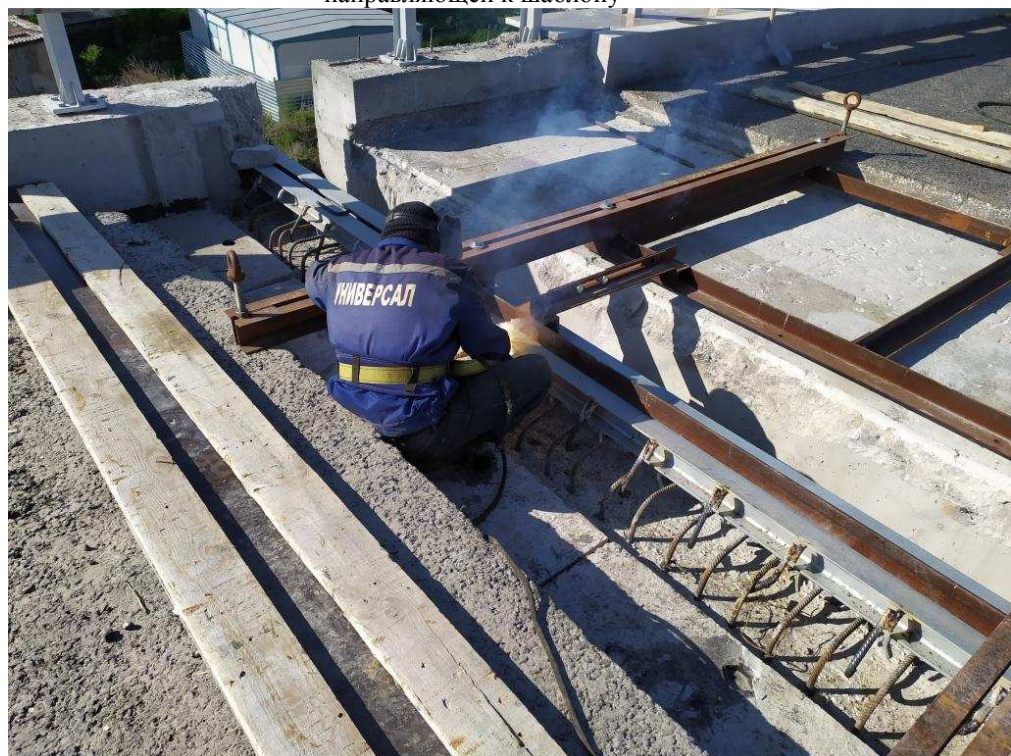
Фиксация поперечной направляющей на сварные прихватки к арматурным анкерам бетонного основания устоя
